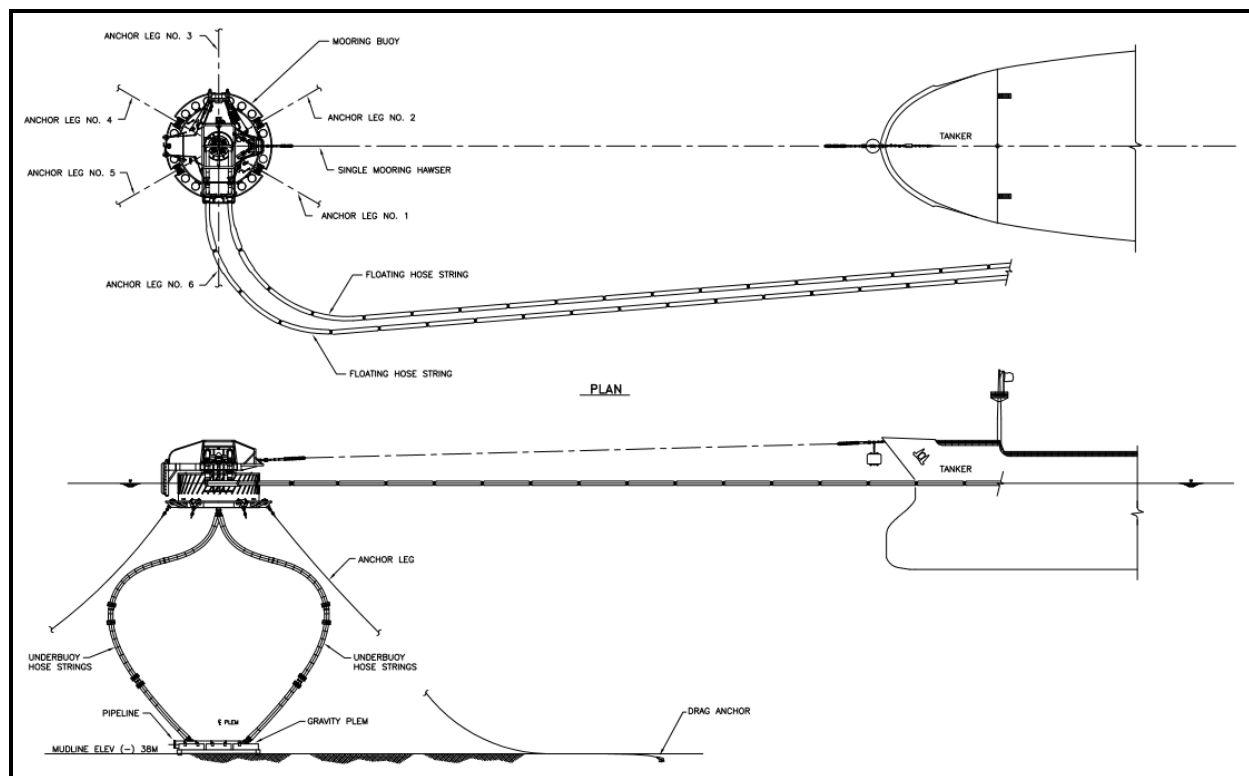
Sección y planta típicas de la Monoboya propuesta para el Proyecto.
